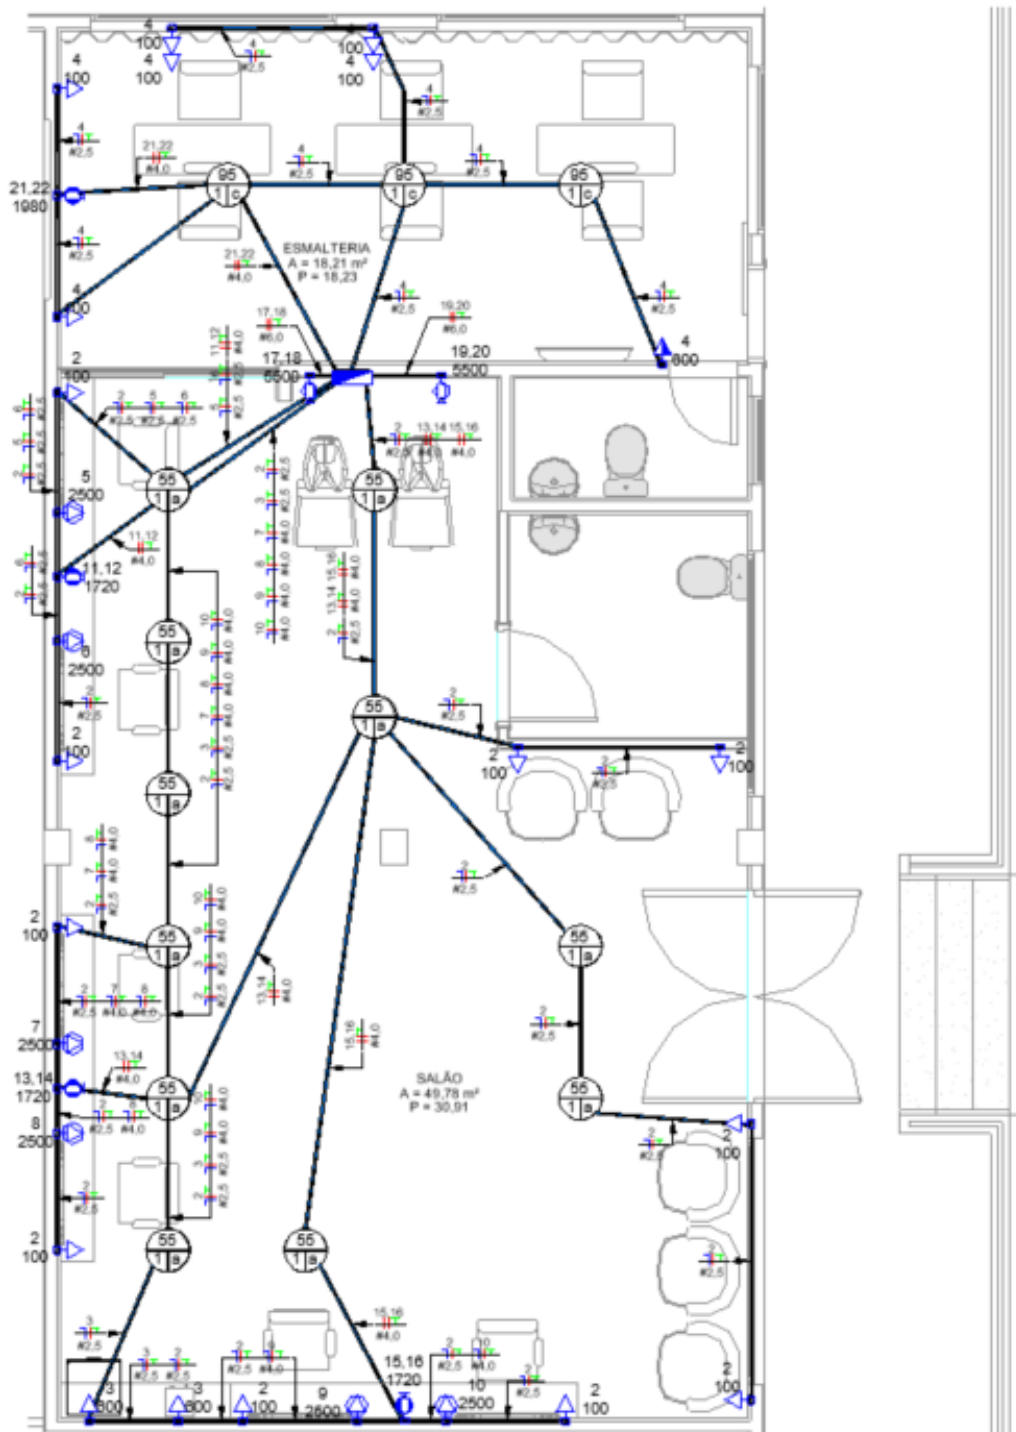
Planta Tomadas – Fonte Autor dia 15/10/2023
